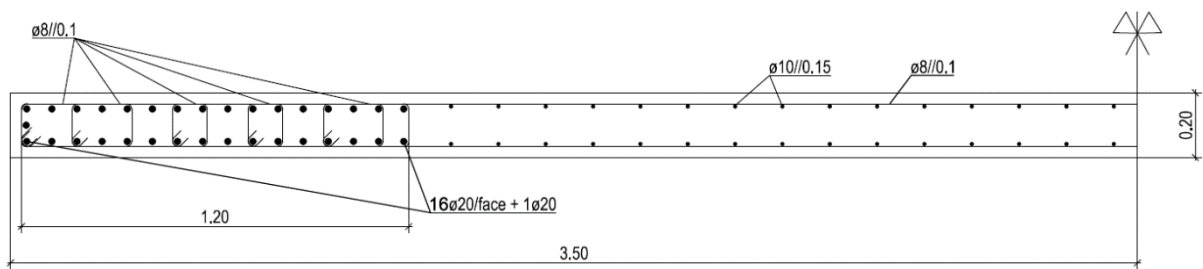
Armadura longitudinal e transversal para as paredes Pa5 e Pa6 para o nível 2
